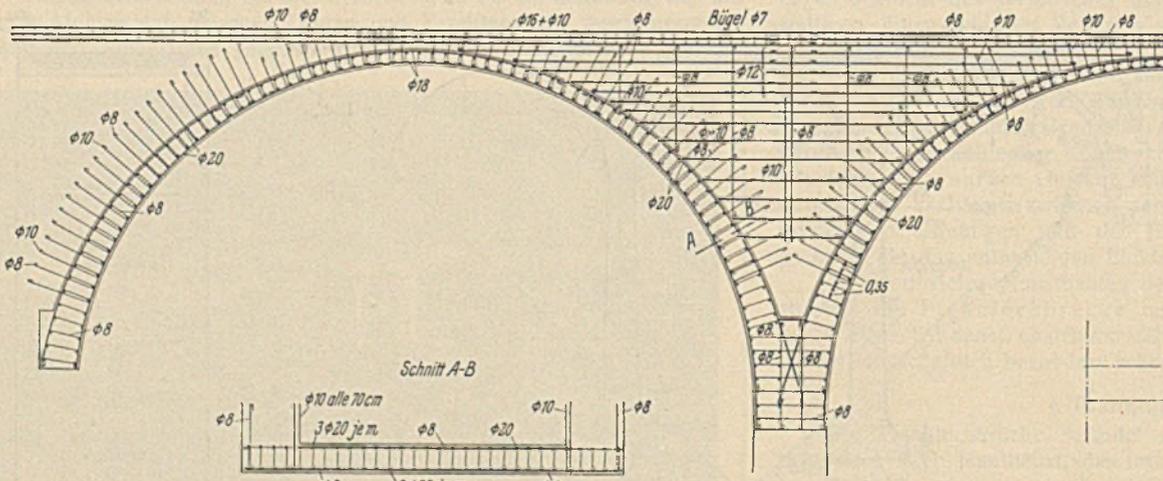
Bewehrung der Gewölbe und Stirnmauern.
